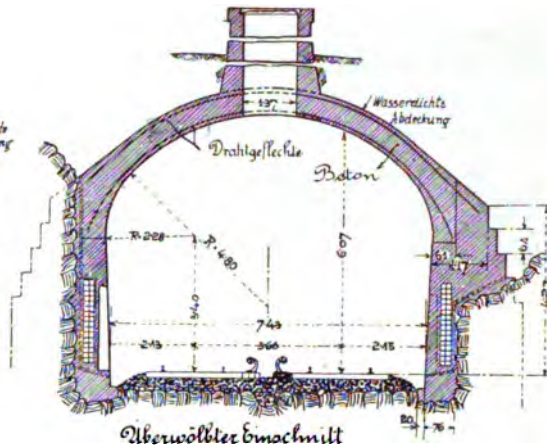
Überwölbter Einschnitt beim St. Marry's Park Tunnel.
